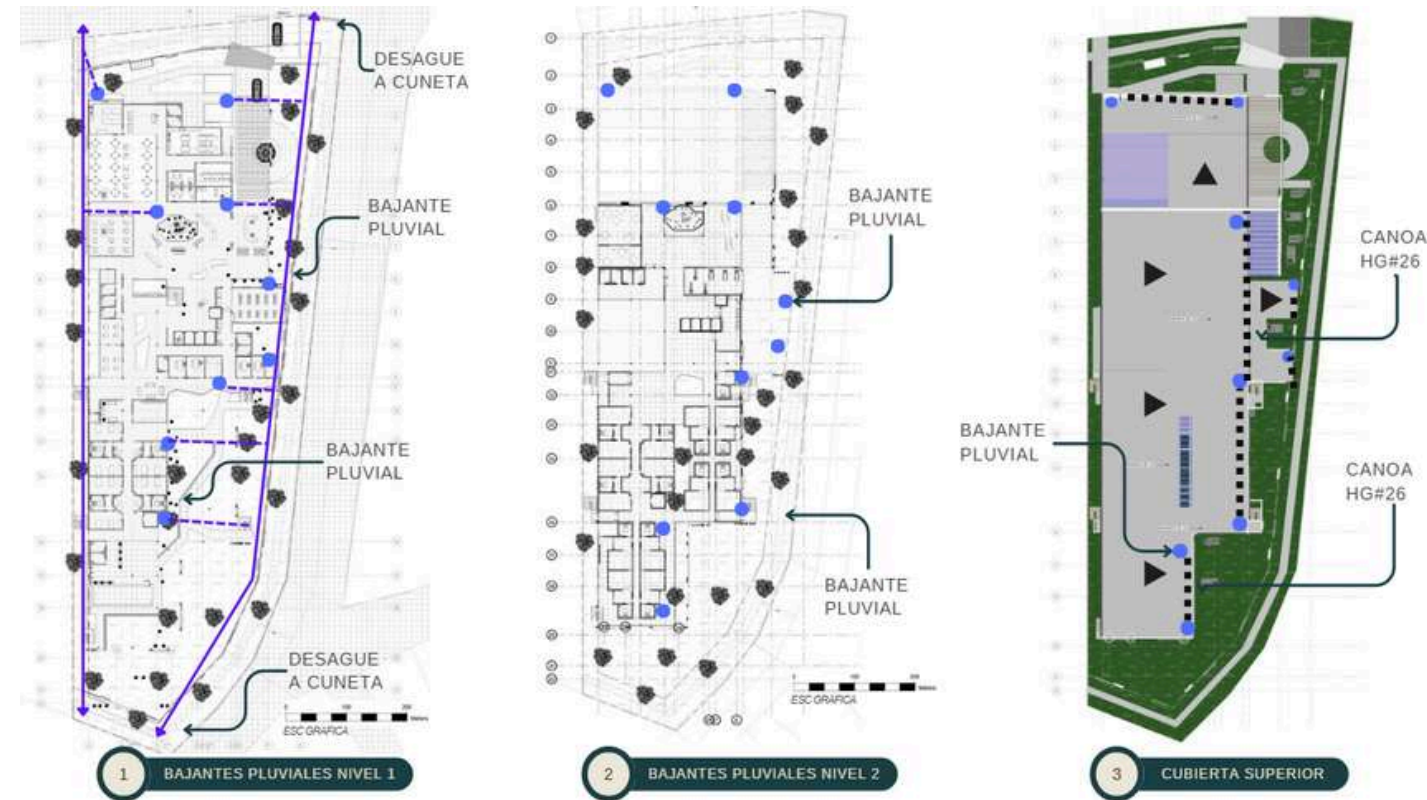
Planta Arquitectónica Evacuación Pluvial.
